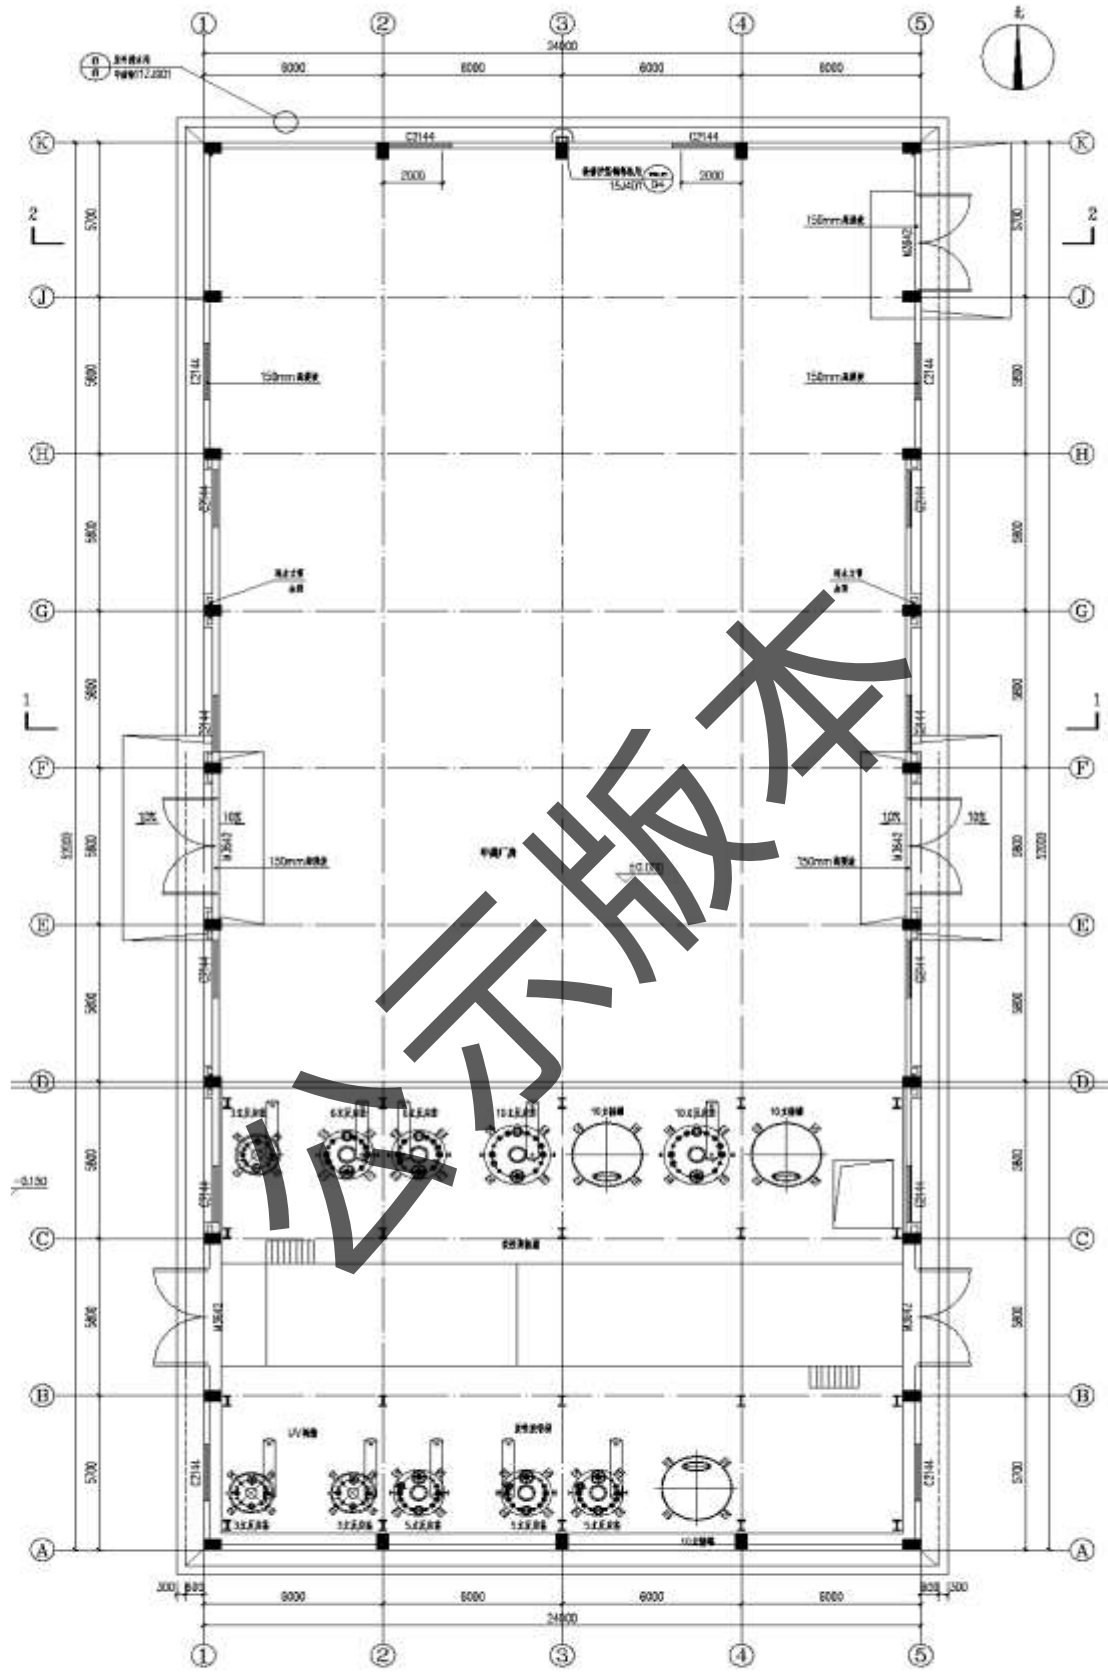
甲类厂房平面布置图（一层钢平台）
